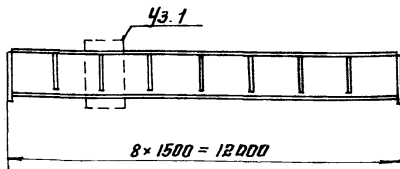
Крепление вертикальных связей к подкрановым балкам:
